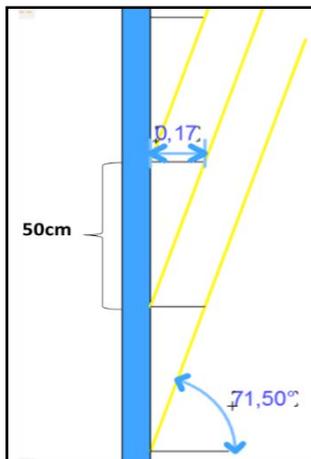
coupe sur les brises soleil de la facade / source : auteur
